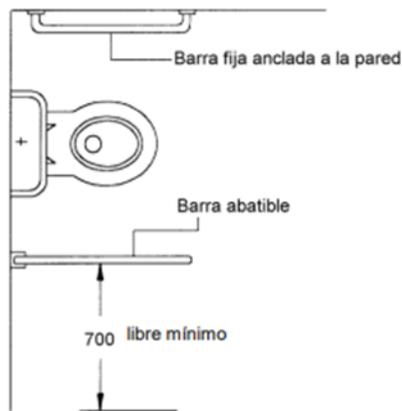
Forma y Disposición de la Barra de Apoyo en Planta para Inodoro
